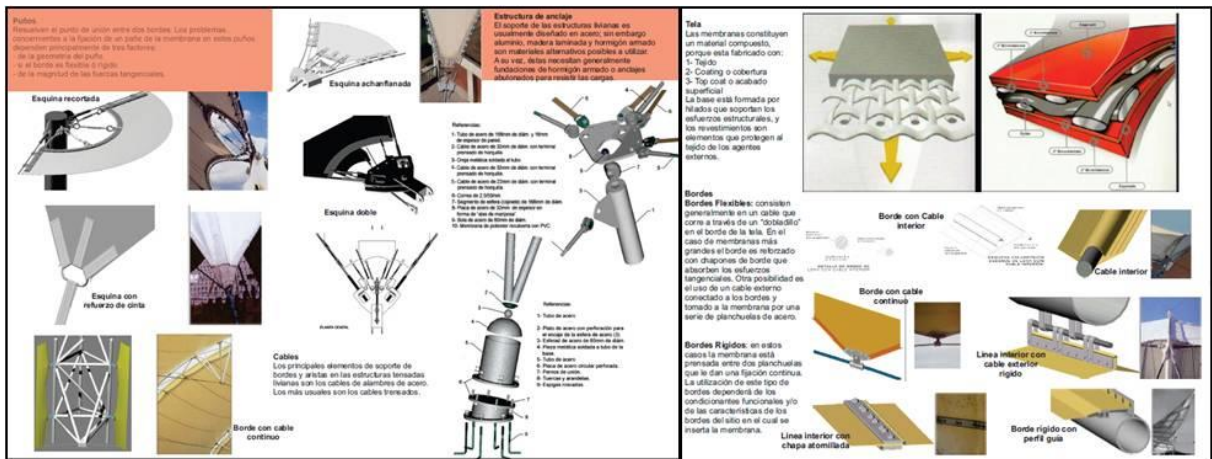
Salón de Usos Múltiples. Membrana. Detalles constructivos. Uniones
